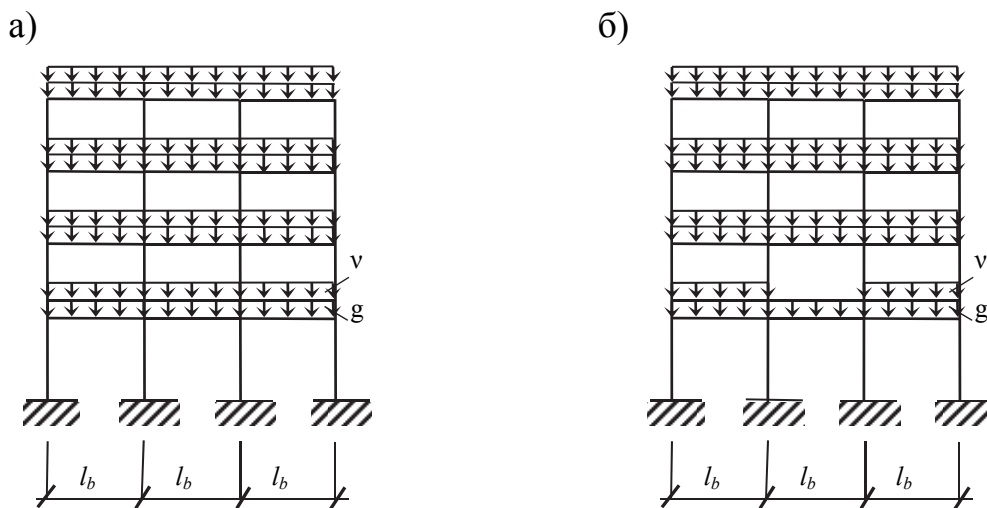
Схемы нагружения многопролетных рам вертикальной нагрузкой при определении усилий в колоннах среднего ряда:
